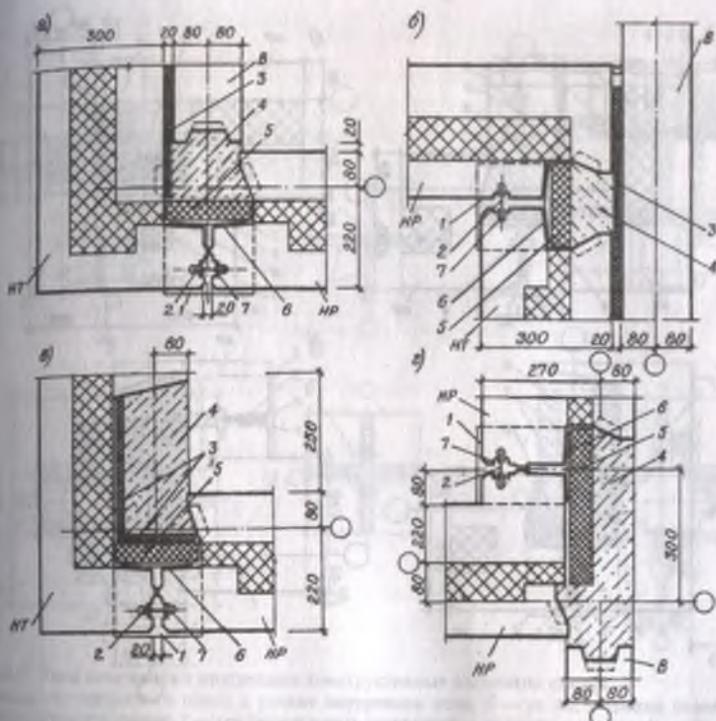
Открытый вертикальный стык наружных стен из трехслойных панелей с гибкими связями:
